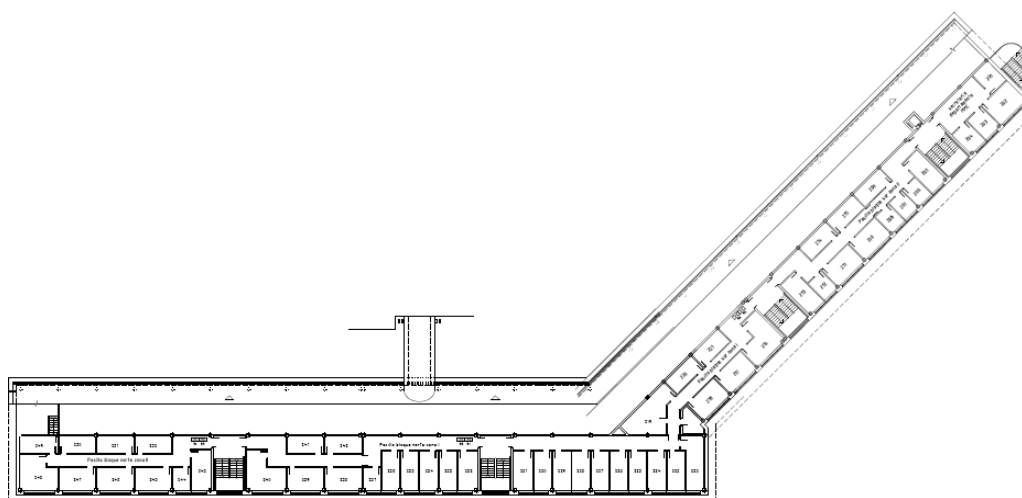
Vista en planta de los espacios en la actual ETSII (Edificio II – Zona III)
